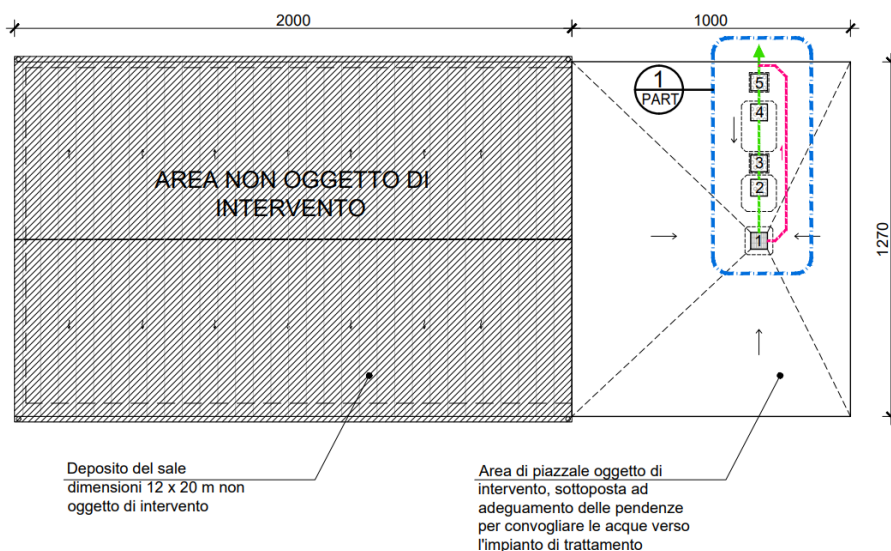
schema di installazione dell'impianto di trattamento a servizio del deposito del sale
